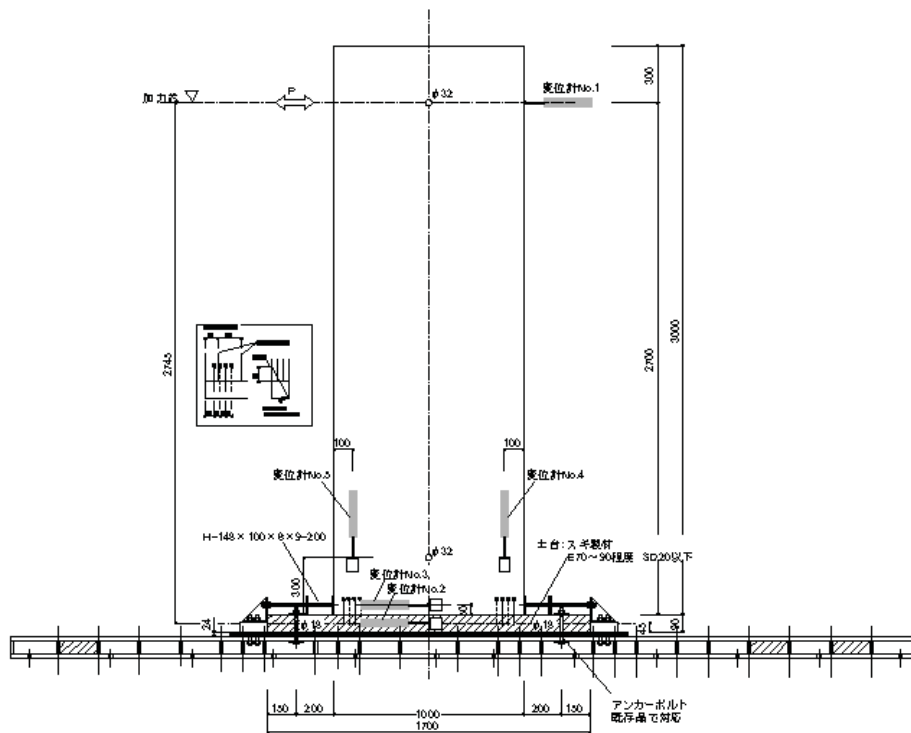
長ビス(1m幅耐力壁) 試験体立面図(NB1-1)
